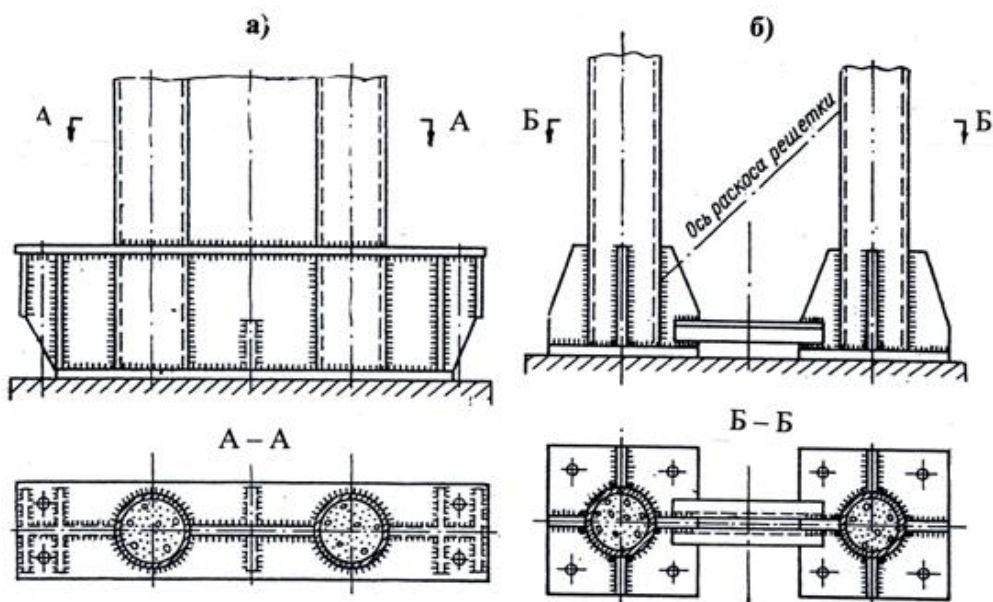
Конструкции баз двухветвевых трубобетонных колонн со сплошным (а) и решетчатым (б) объединением ветвей [3]
